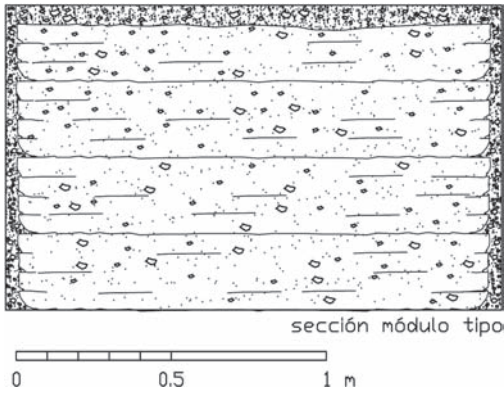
Sección transversal del módulo tipo FT/TT/CC correspondiente al primer momento constructivo, siglos XIII-XIV hasta el siglo XIX.
